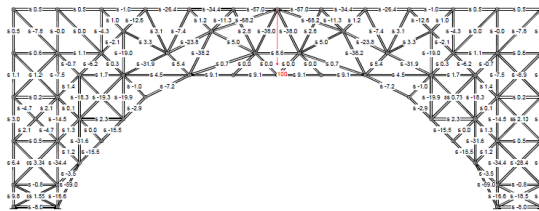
Esfuerzos a Tensión máximos de los miembros de la armadura propuesta ante la aplicación de la carga. (Equipo 1, segundo reporte, anexo C3)
